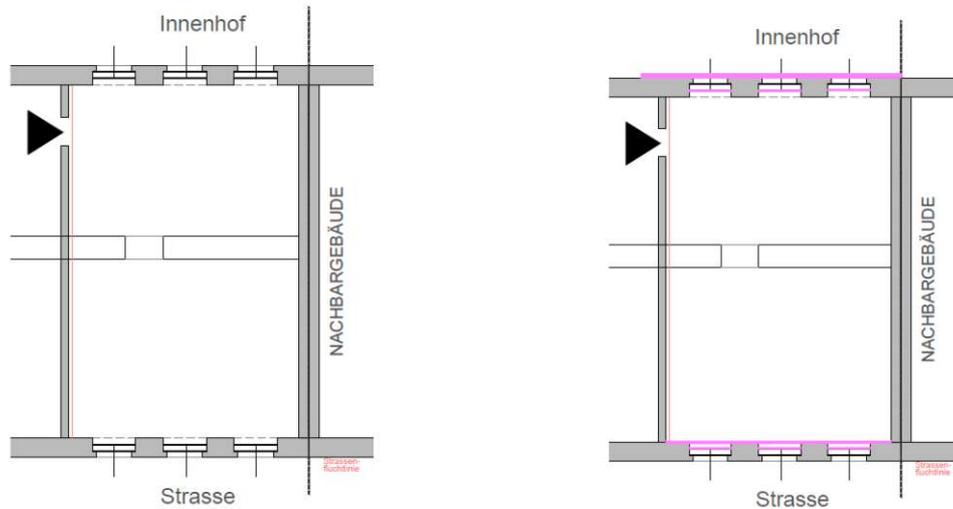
Systemgrundriss 3. Stock unter Dachboden: Bestand – Saniert (eigene Darstellung)
